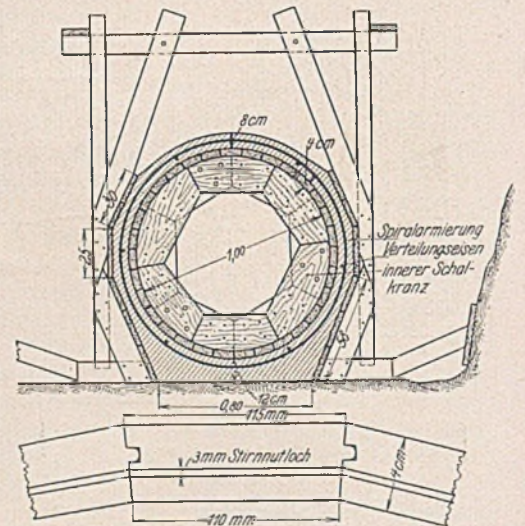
Hangrohrleitung Vöhrenbach. Querschnitt mit Schalung.
